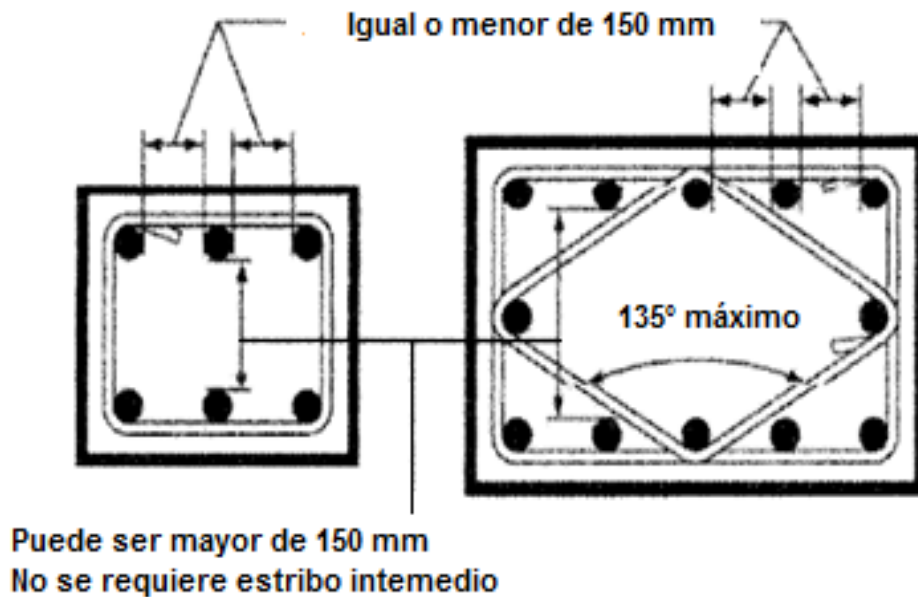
Medidas entre barras de columna apoyadas lateralmente
